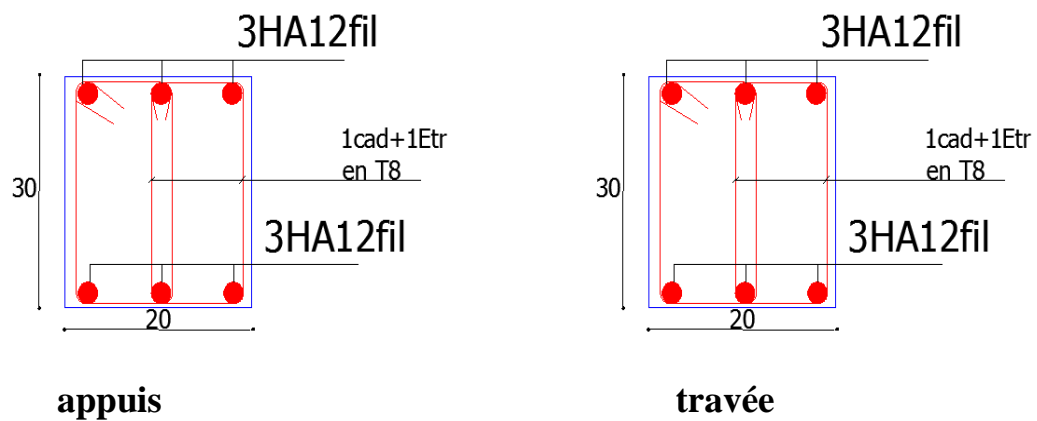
schéma de ferrailage de la poutre de chaînage
